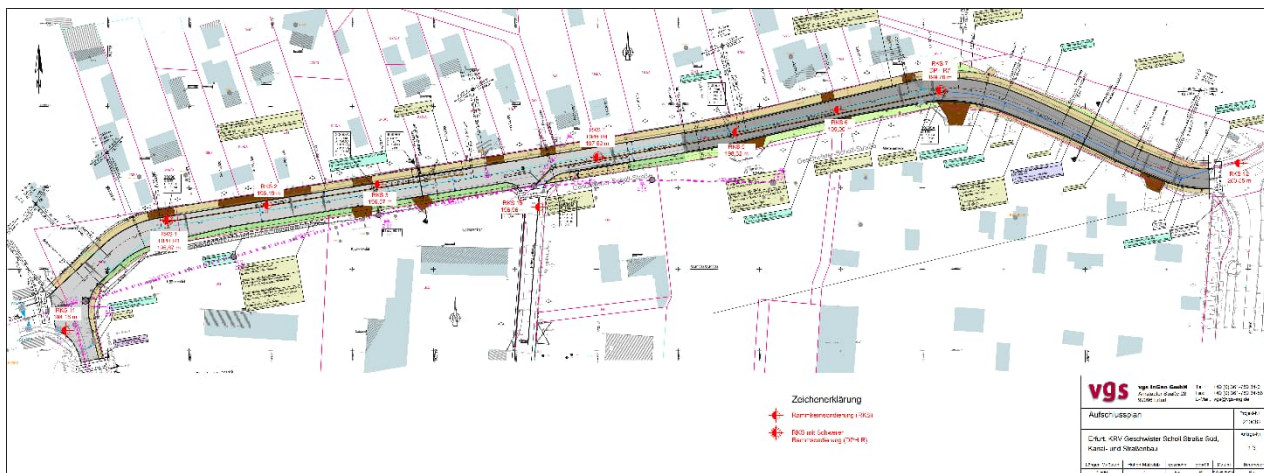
Aufschlussplan aus Anlage 1.3 des Baugrundgutachtens
